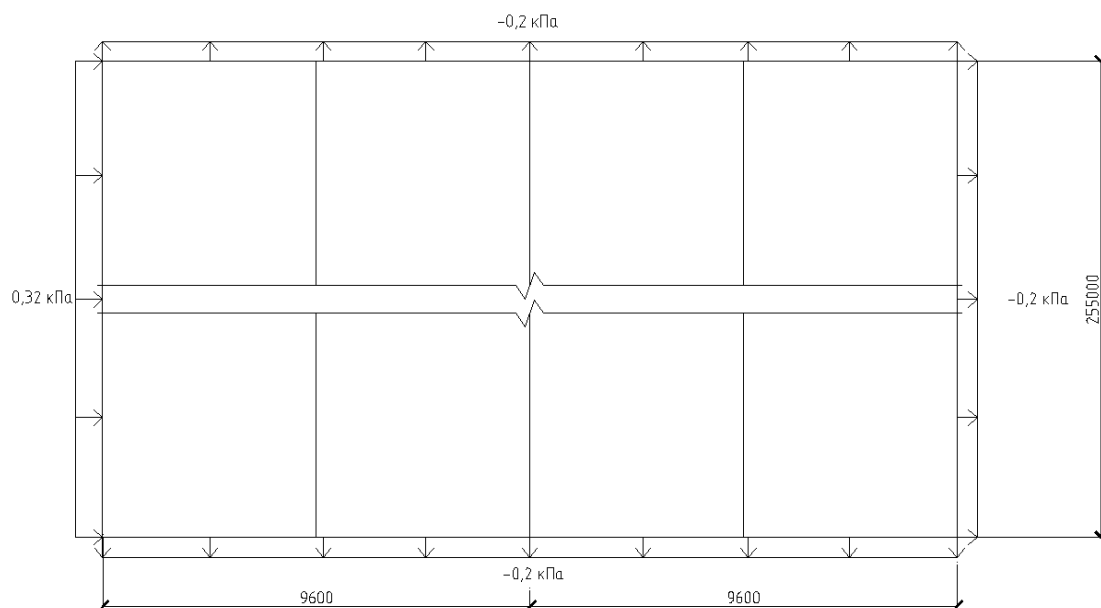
Расчетная схема для сбора ветровой нагрузки
